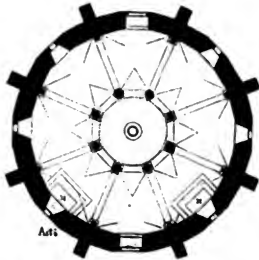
Grundriss von S. Pietro zu Asti.
